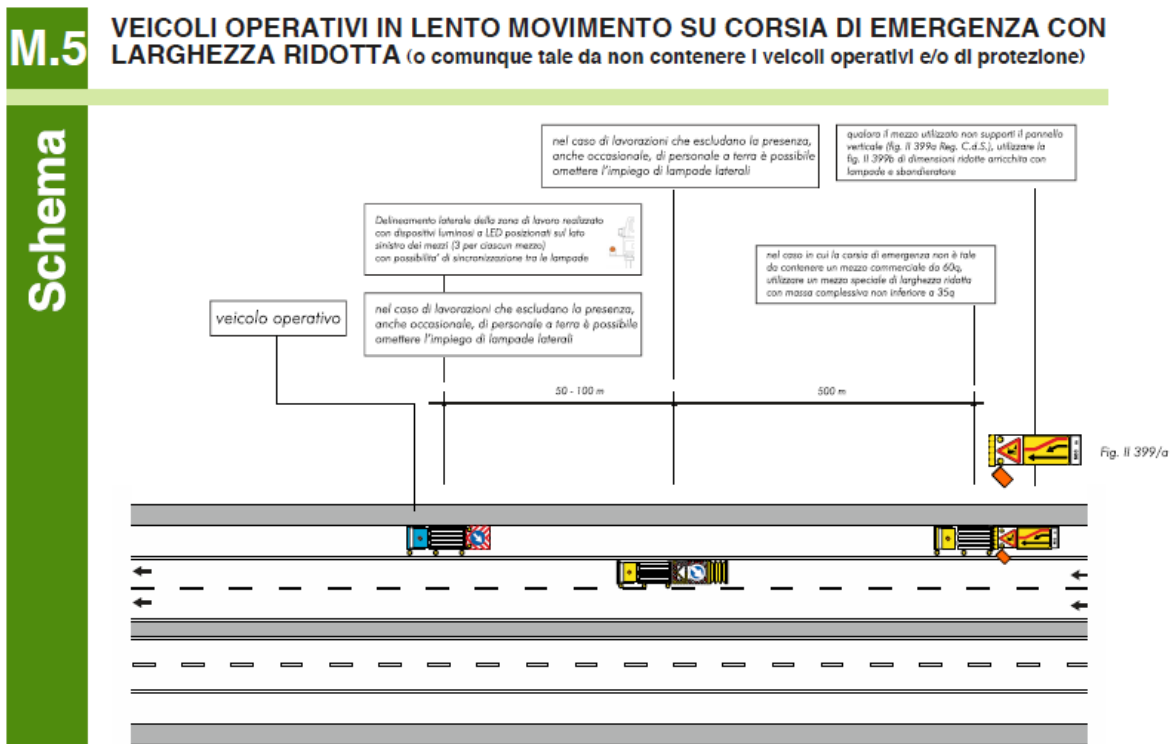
Tecne [3] Tavola M5- Cantieri in avanzamento con larghezza della corsia di emergenza ridotta
